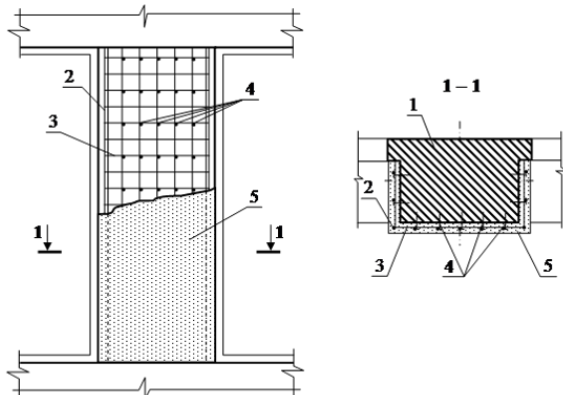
Усиление кирпичной стены железобетонной обоймой. 1-усиливаемый простенок, 2-продольная арматура класса АШ Ø6-12, 3-поперечная арматура класса АІ Ø6-10, 4-металлические гвозди длиной 100-150 мм., 5-железобетонная рубашка толщиной 60-100 мм (класс бетона В15-В20)
